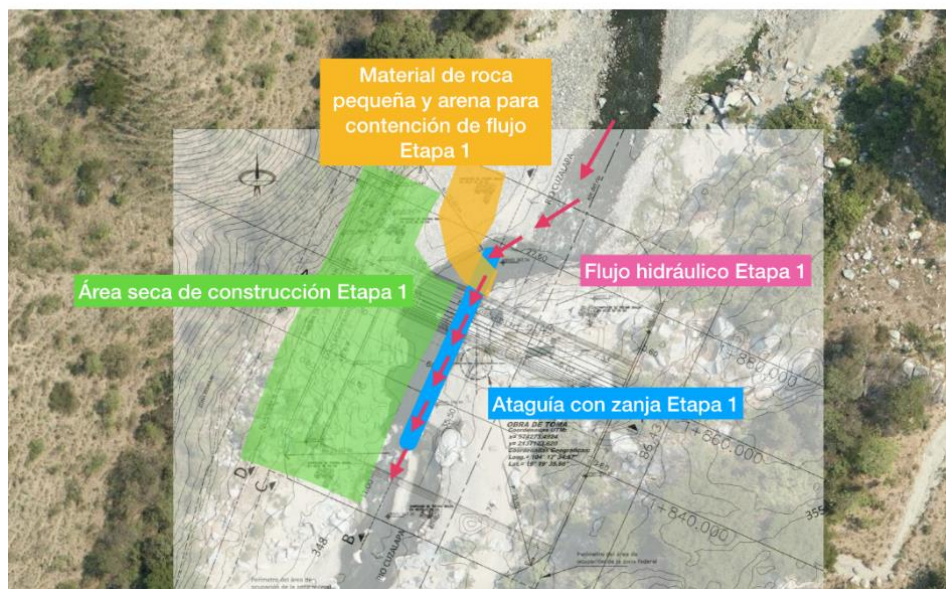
Etapa 1 Construcción de obra de toma, compuerta y canal
